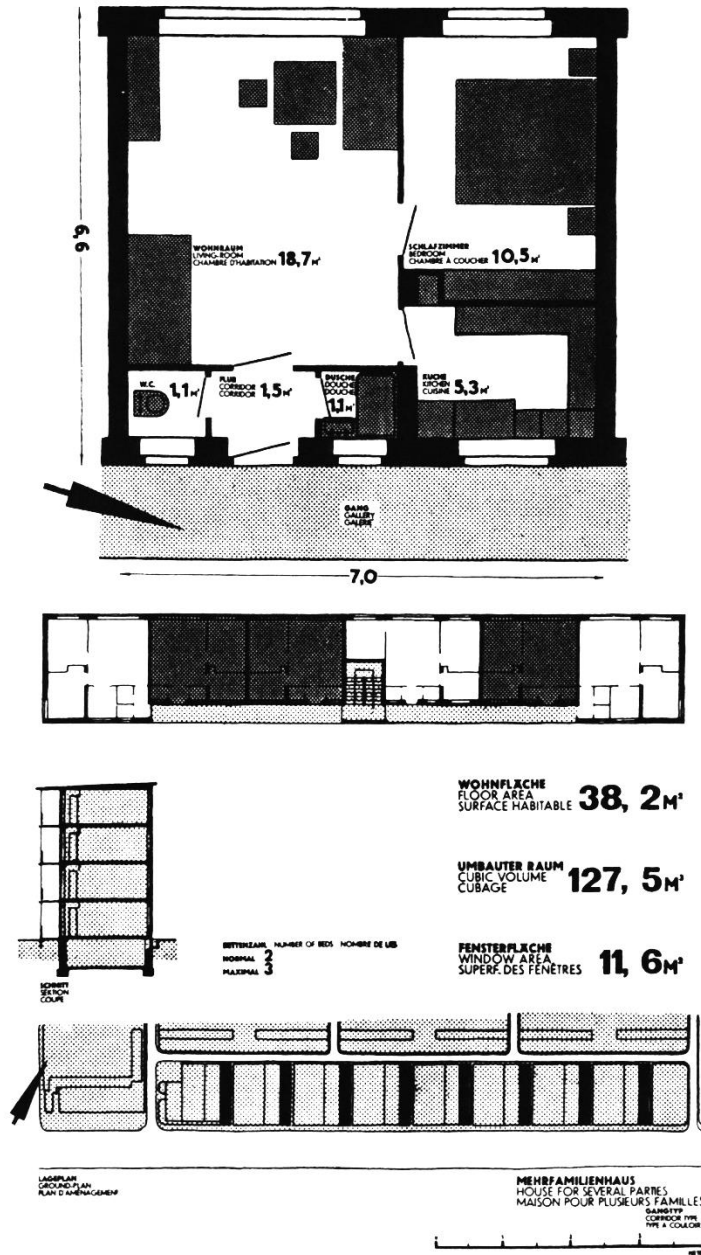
Grundriss Zweizimmerwohnung (Beispiel 115)
